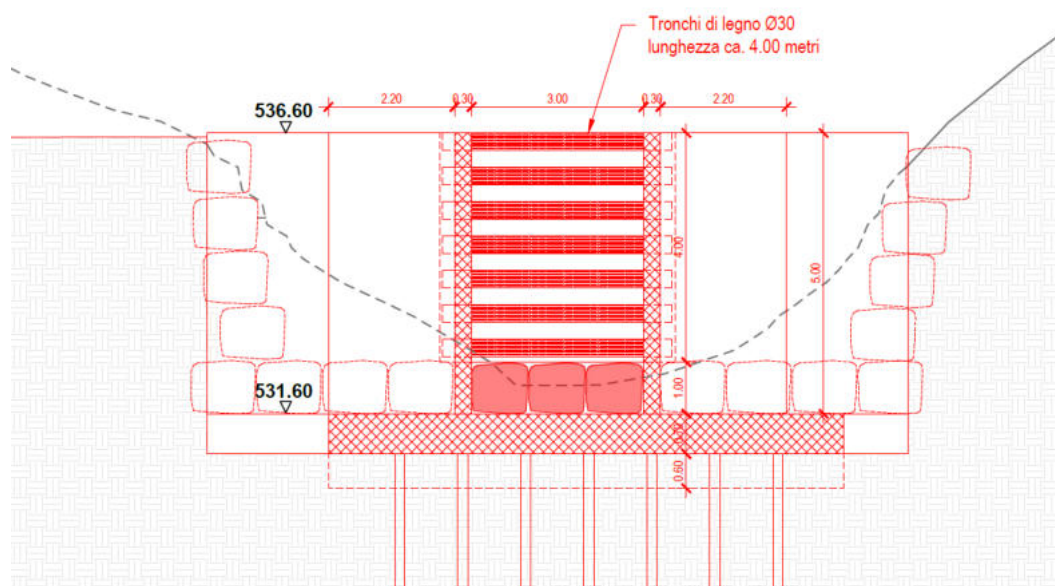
ZONA 3, camera di raccolta in c.a., vista frontale (estratta dal piano allegato).
